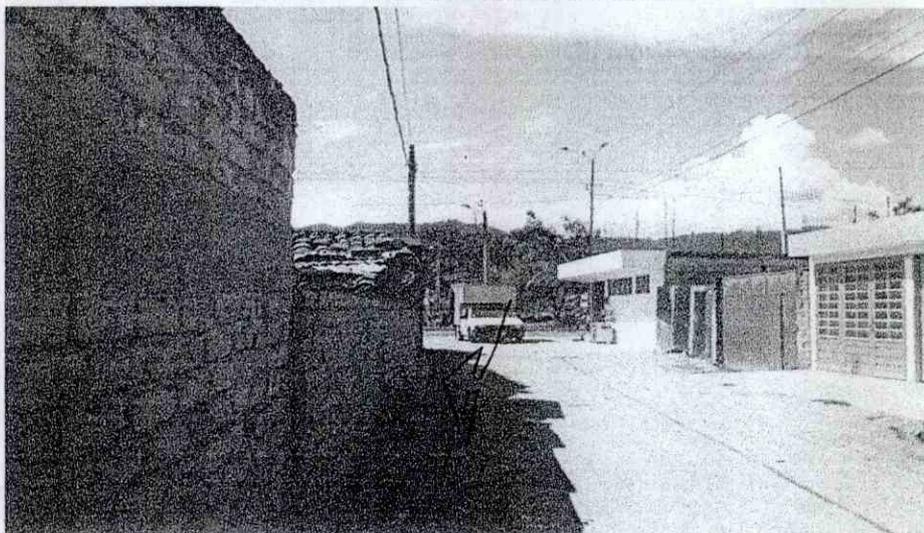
FACHADA DEL INMUEBLE SOBRE LAS DOS VIAS HACIA EL CENTRO
